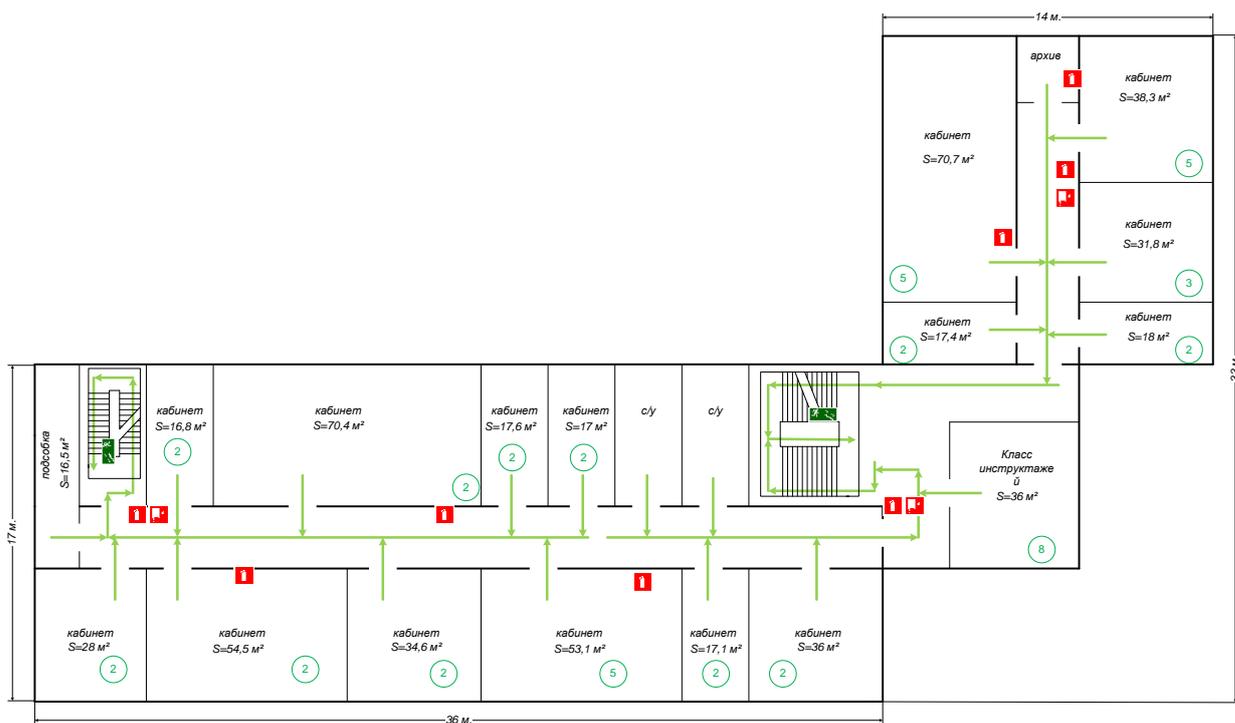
Схема эвакуации из помещений 3-го этажа
